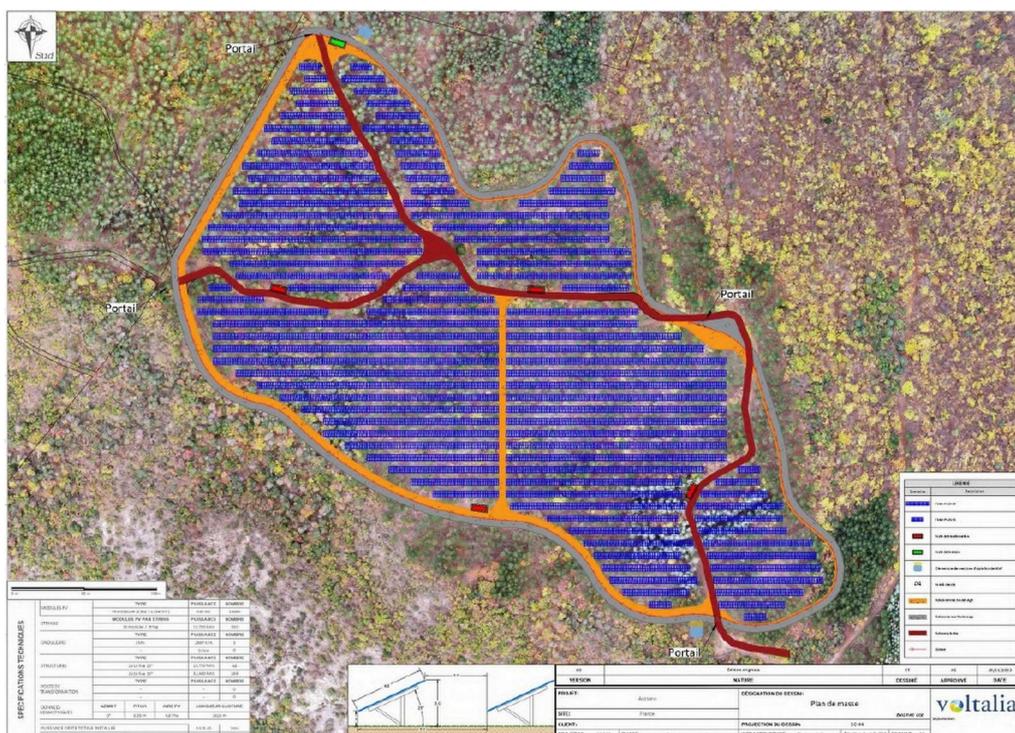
Plan de masse du projet de parc solaire photovoltaïque AUSSANO.
